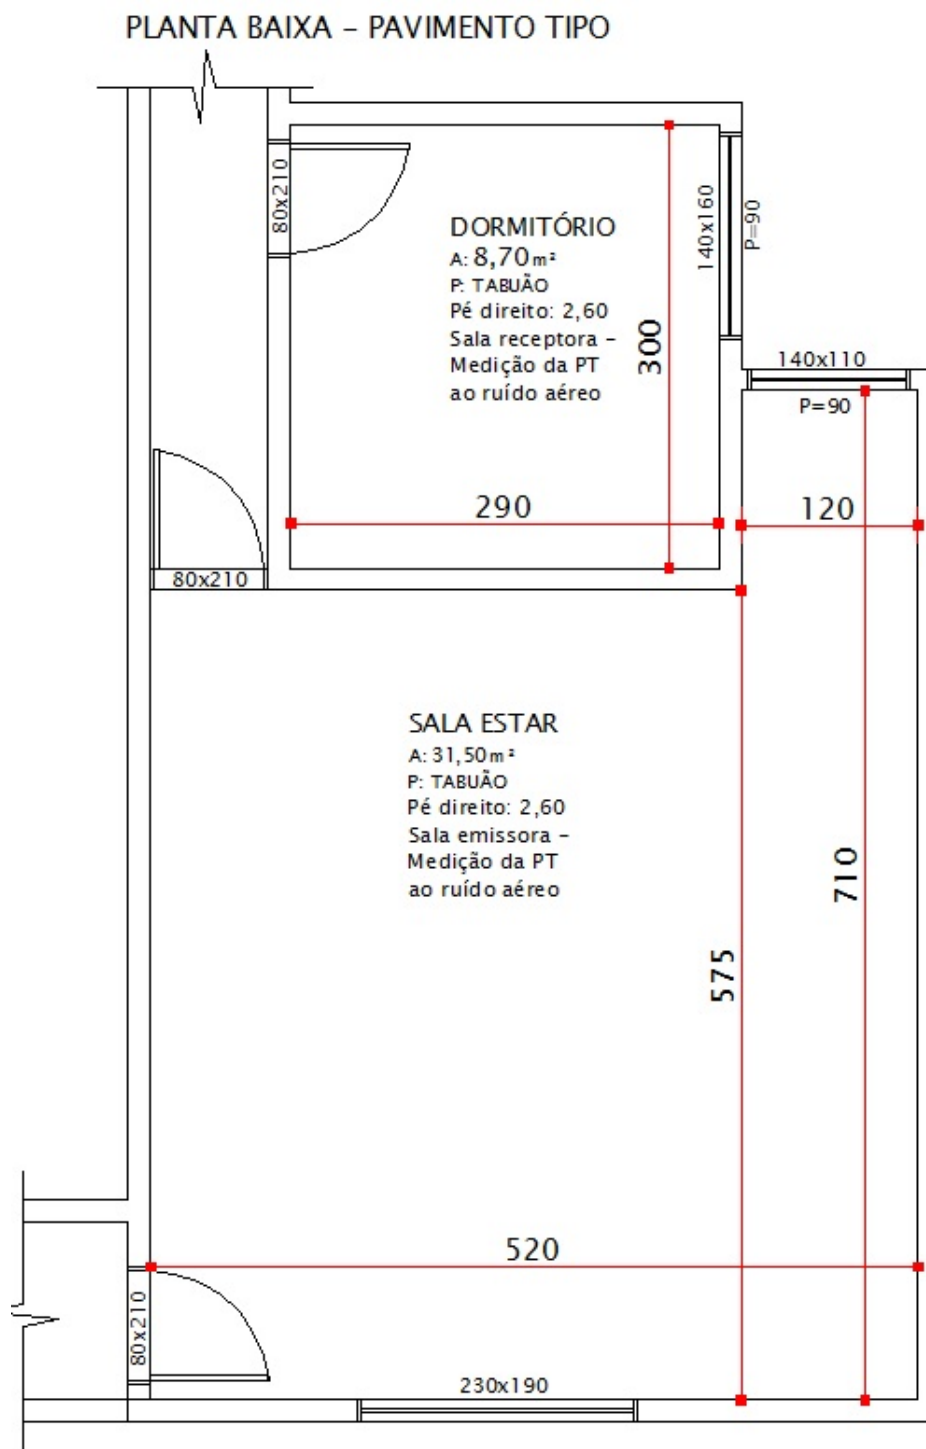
Planta baixa - pavimento tipo - 19-R8-A-TV
